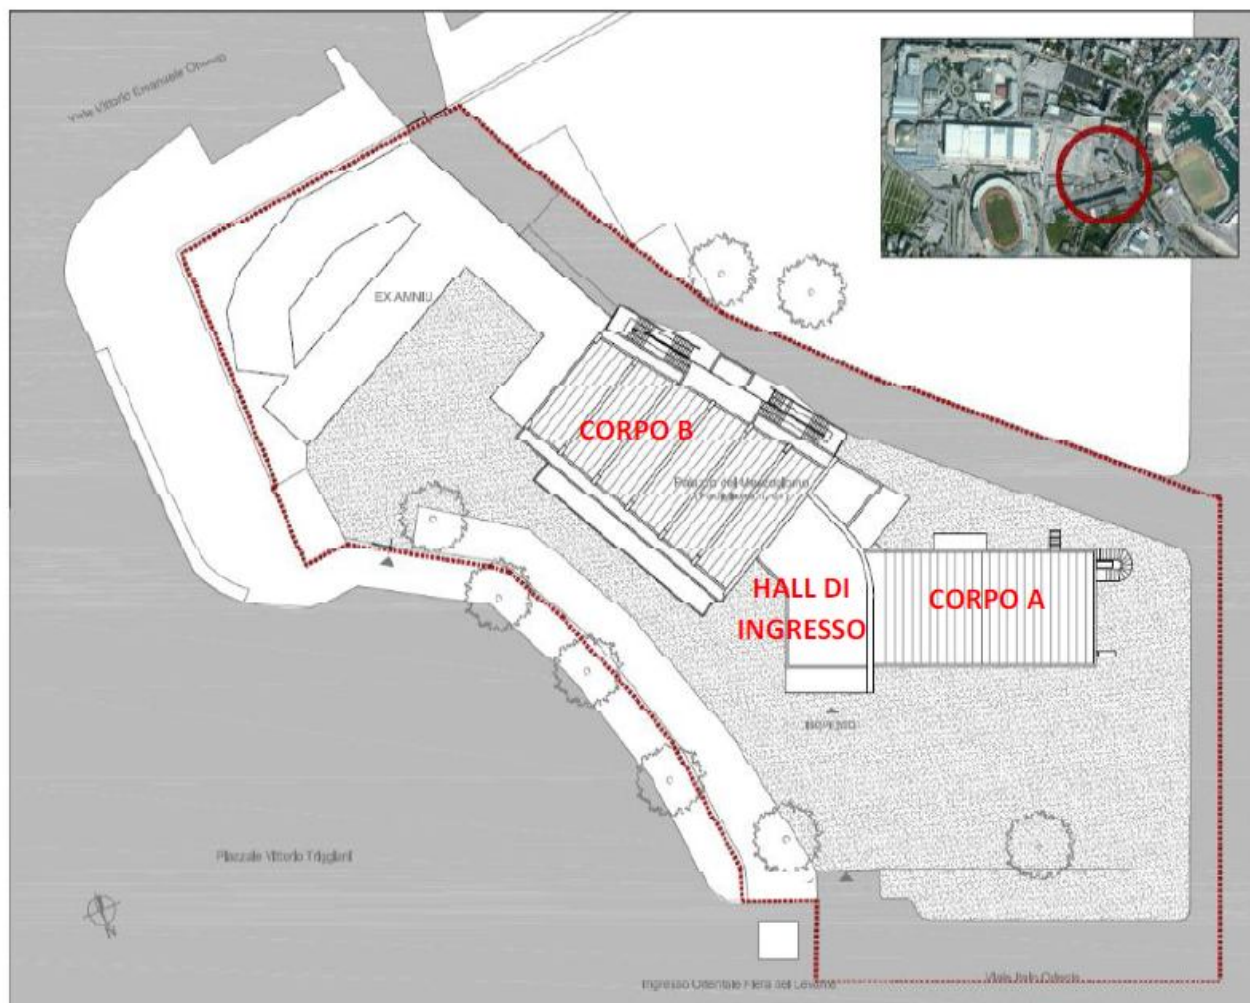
Rilievo - Planimetria generale e perimetrazione dell'area di intervento
